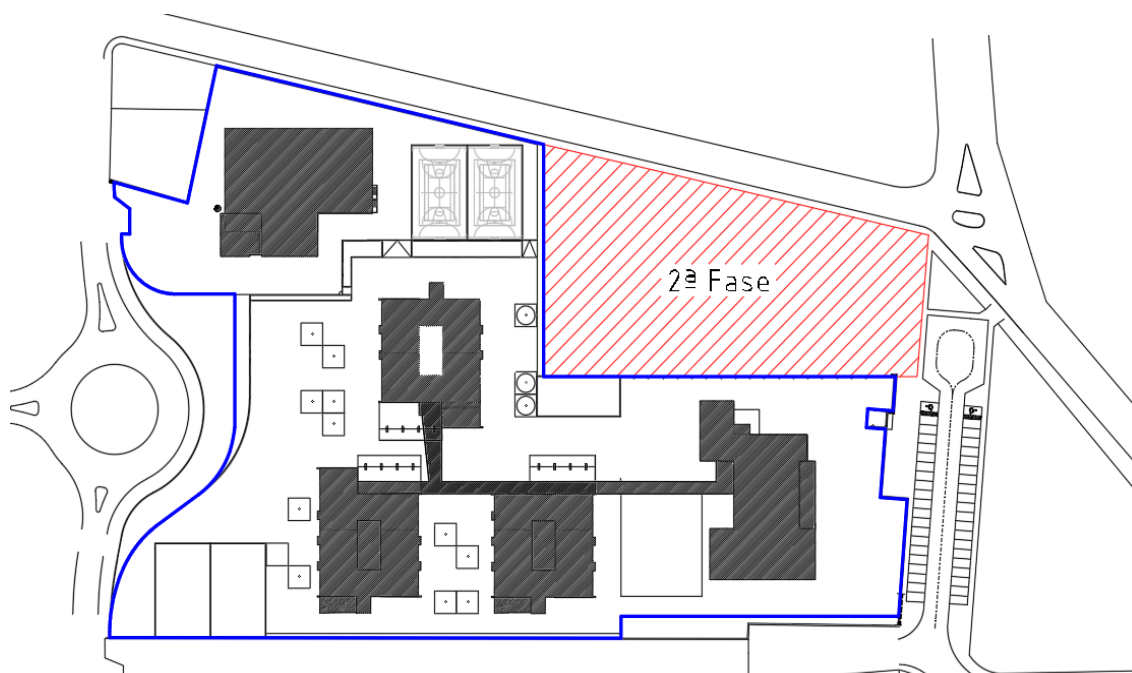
Planta de Implantação da escola EB 1 Feira Centro (a construir). Área a intervir, a azul. Área excluída da intervenção em estudo (2ª fase) a vermelho. [33]
